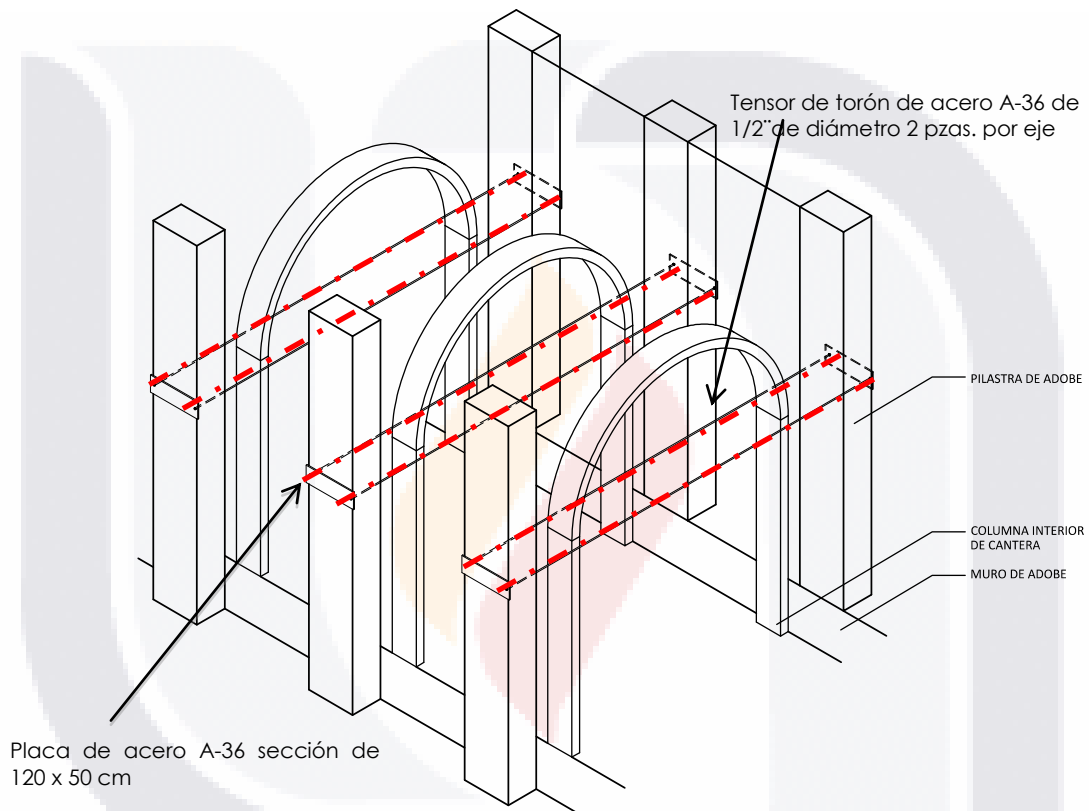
Isométrico de una sección de la capilla en donde se muestra la disposición de los elementos de refuerzo (tensores).
